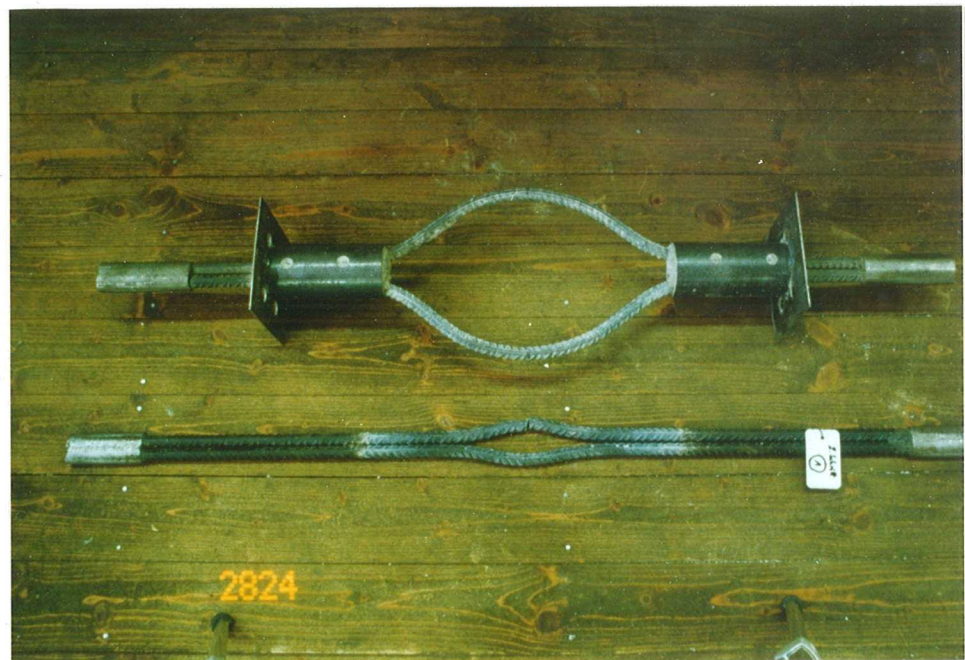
Vergleich der Biegeformen der eingelegten Stabstahlpaare des
